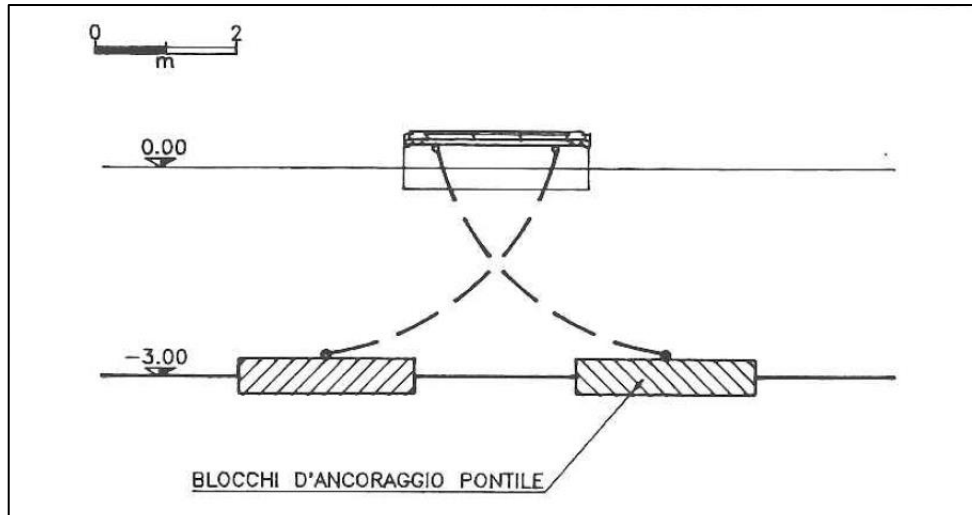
Schema tipico di ancoraggio di un pontile galleggiante. Vista in sezione.
